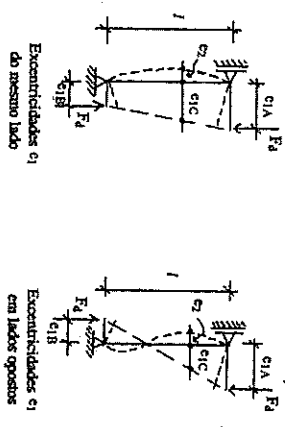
Esquemas estruturais para um segmento de pilar situado entre dois pavimentos
